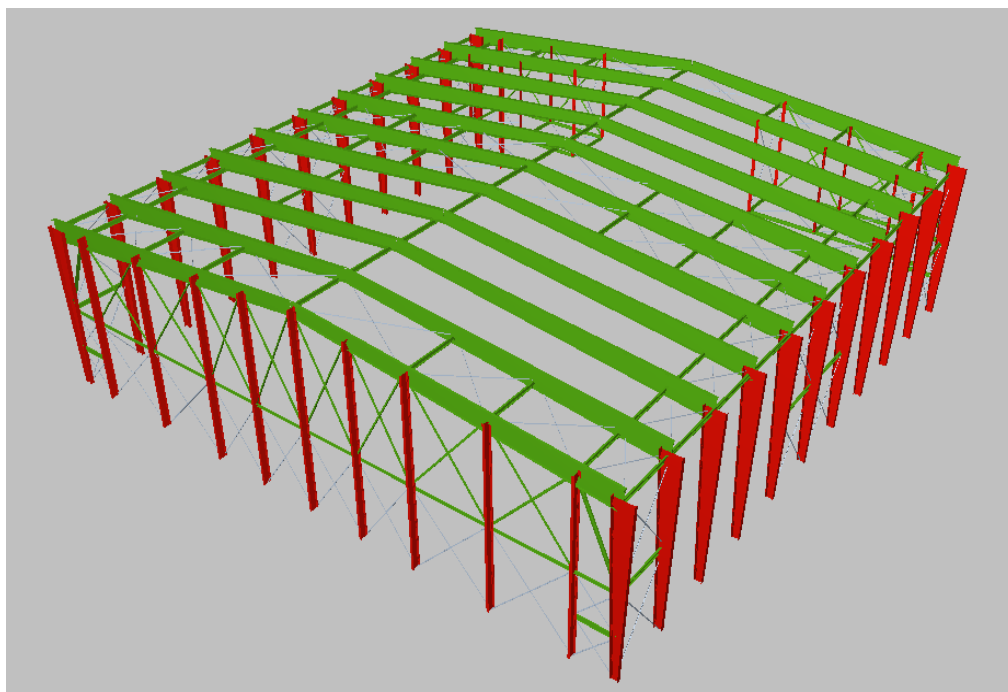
Vista en 3D de la parte trasera de la estructura metálica final del hangar vista en CYPE 3D.
